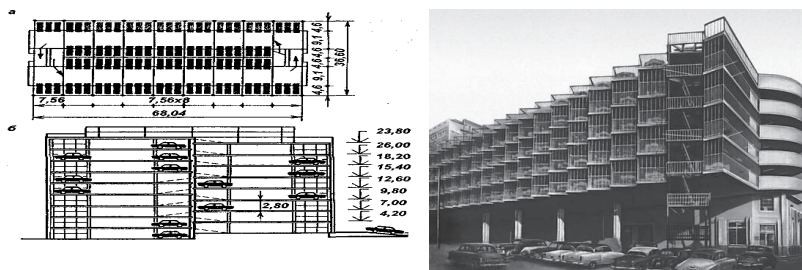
Крупный полурамповый гараж: а – план типового этажа; б – разрез
